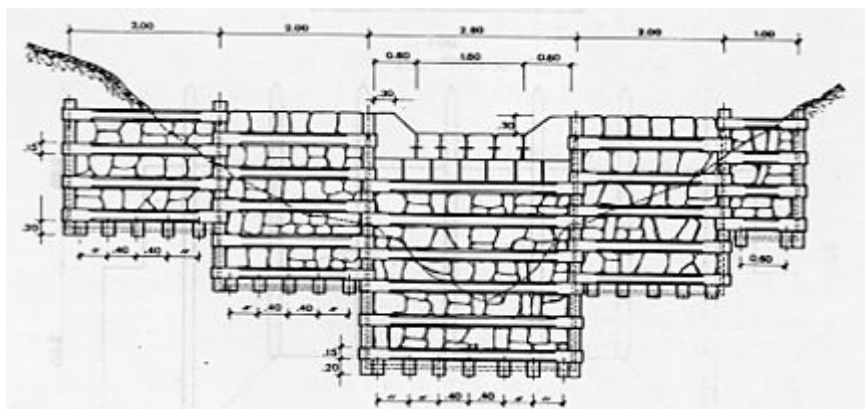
Prospetto di briglia in muratura cellulare progettata dall'ingegnere Andreocci (1929)
